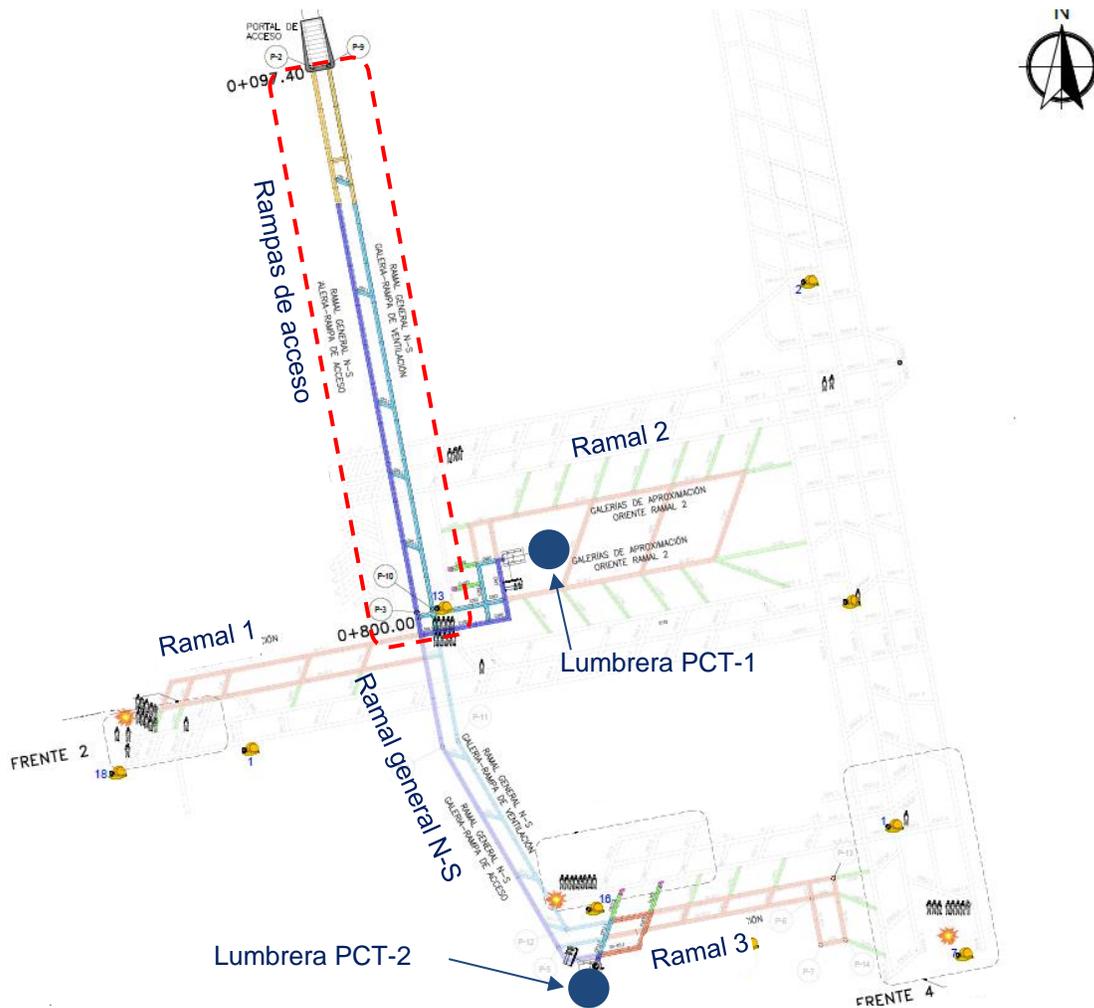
Esquema general de obras subterráneas. Excavación de rampas de acceso y ventilación.
